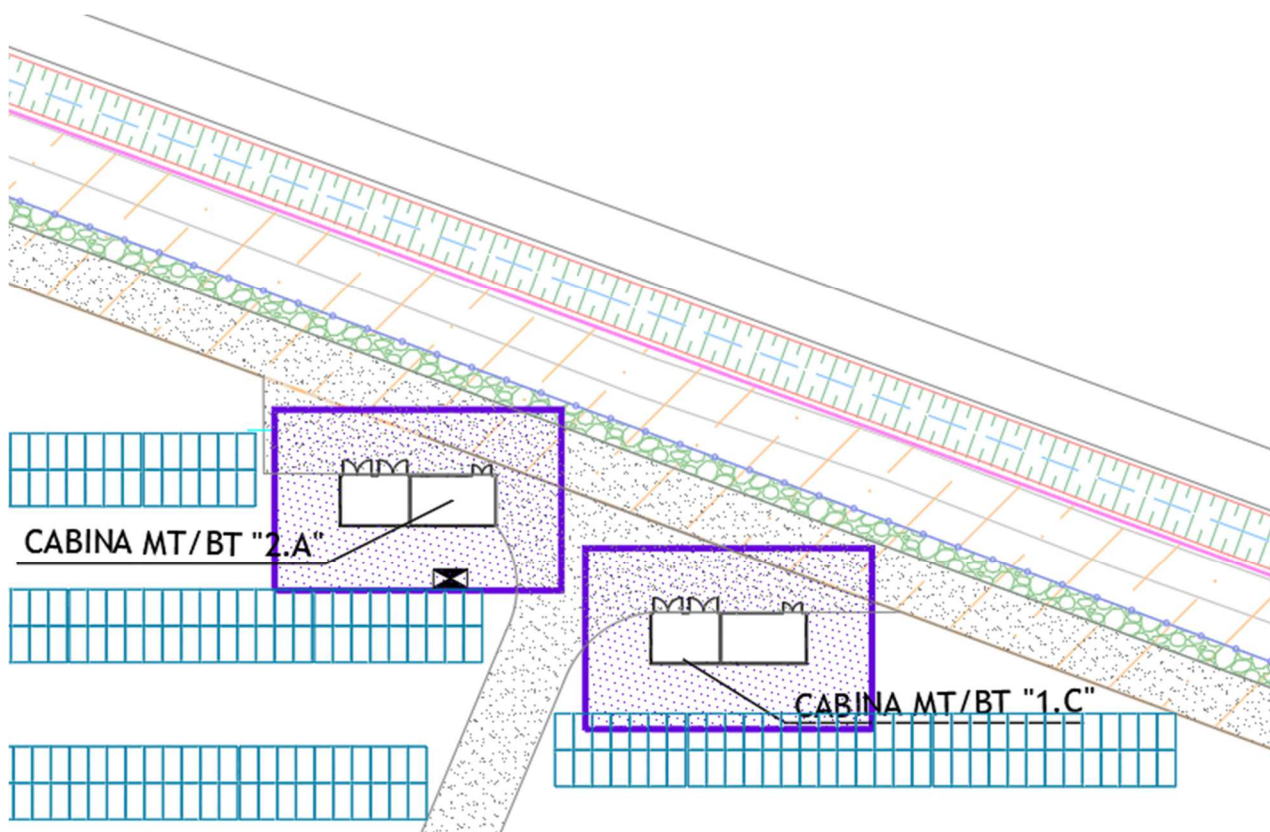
Individuazione fasce di rispetto Cabine MT/BT 1.C e 2.A
